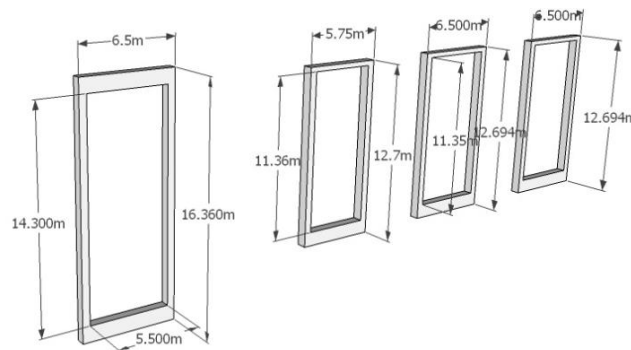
Ubicación de los muros – Superboard, fachada sur
